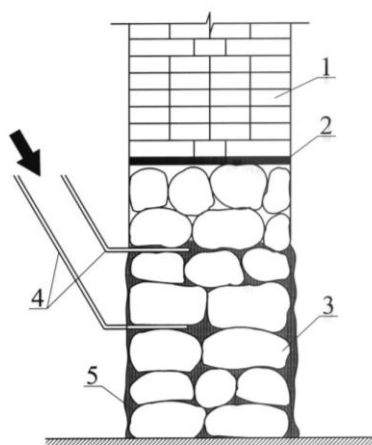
Усиление бутового фундамента методом цементации: 1 – кирпичная стена;
